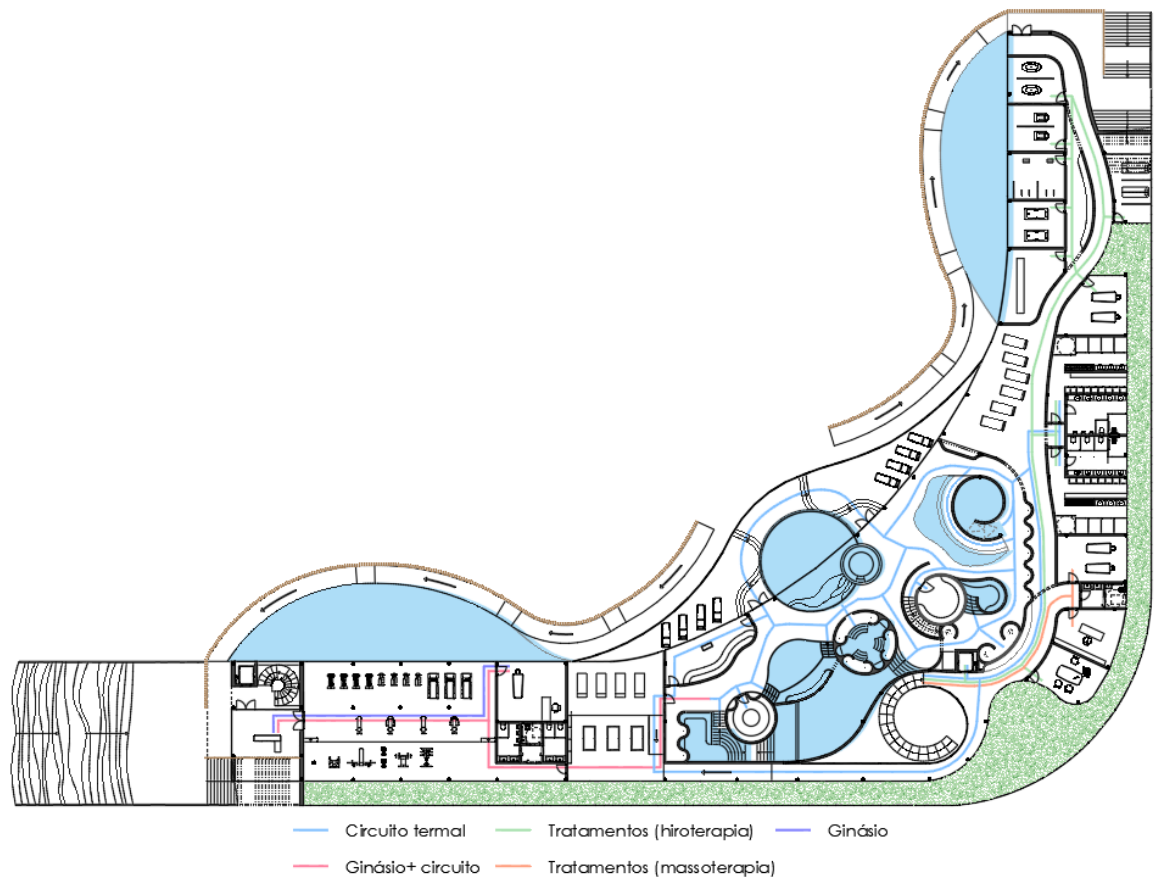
PLANTA DE CIRCULAÇÃO- ESQUEMA DE UTILIZAÇÃO
